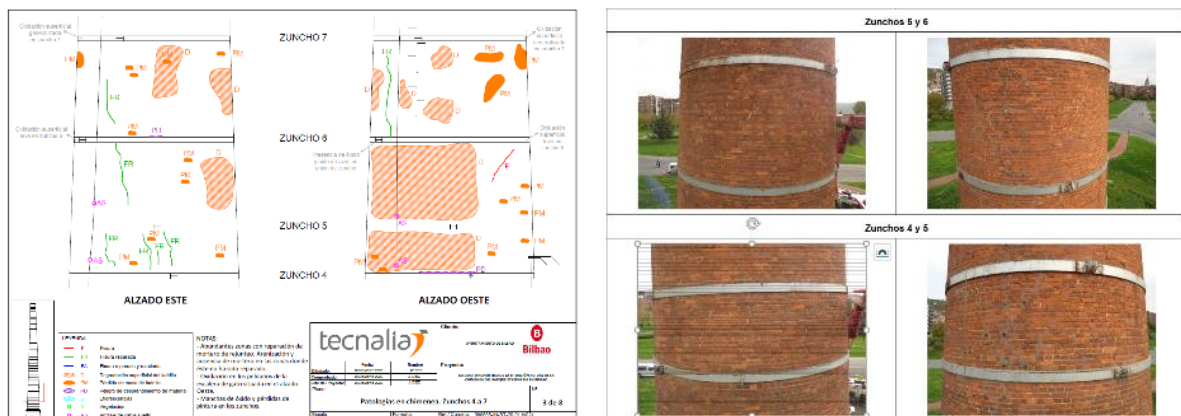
Vista planos de daños y reportaje fotográfico tipo.
